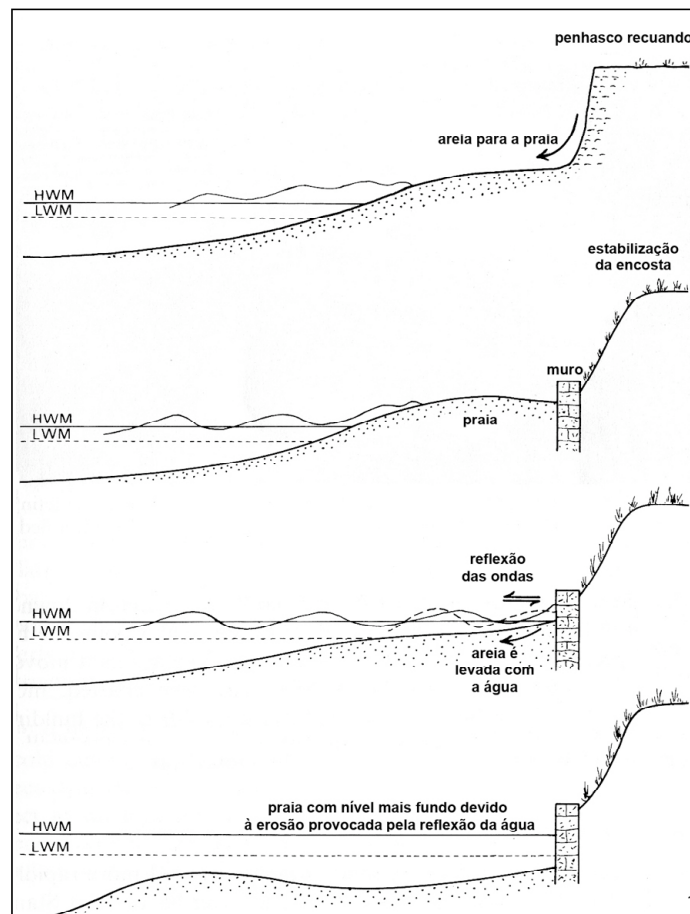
estabilização de encosta com muro e posterior erosão da praia (adaptado de BIRD, 1996, p.105)
